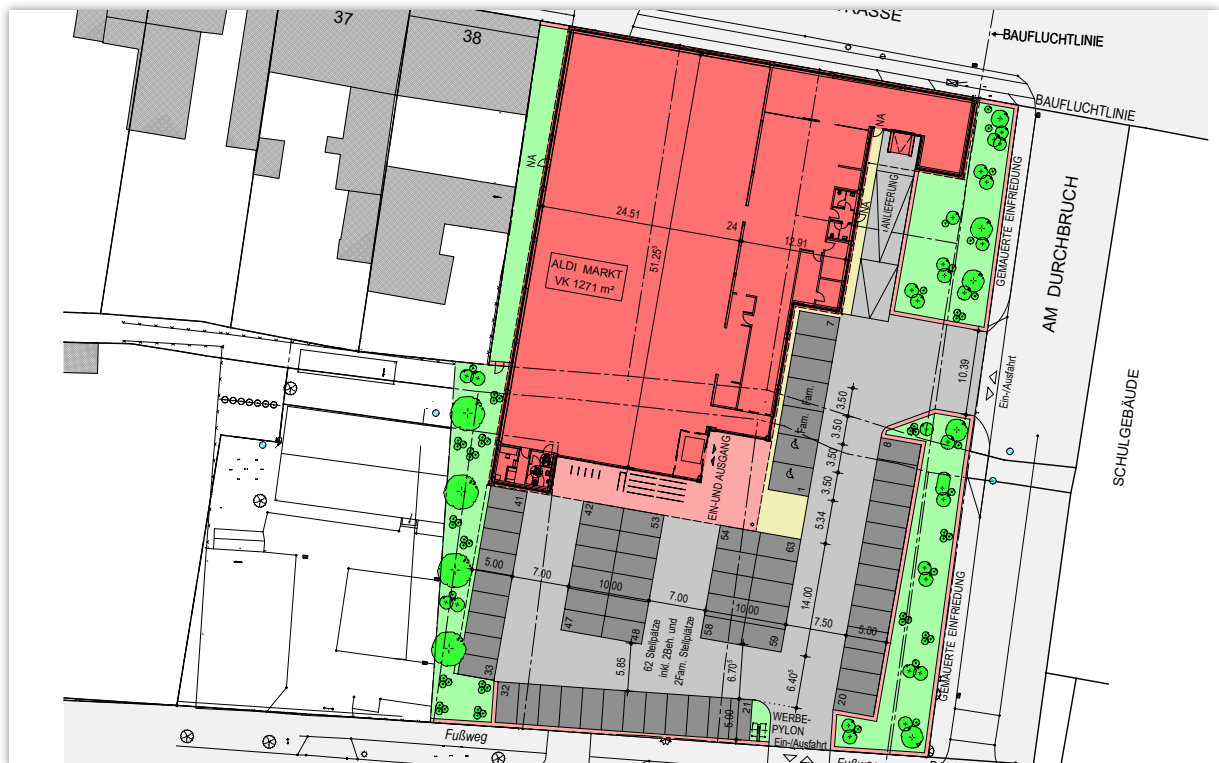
Lageplan des Architekturbüros Planer in der Pankemühle (Stand: 07.09.2018)
